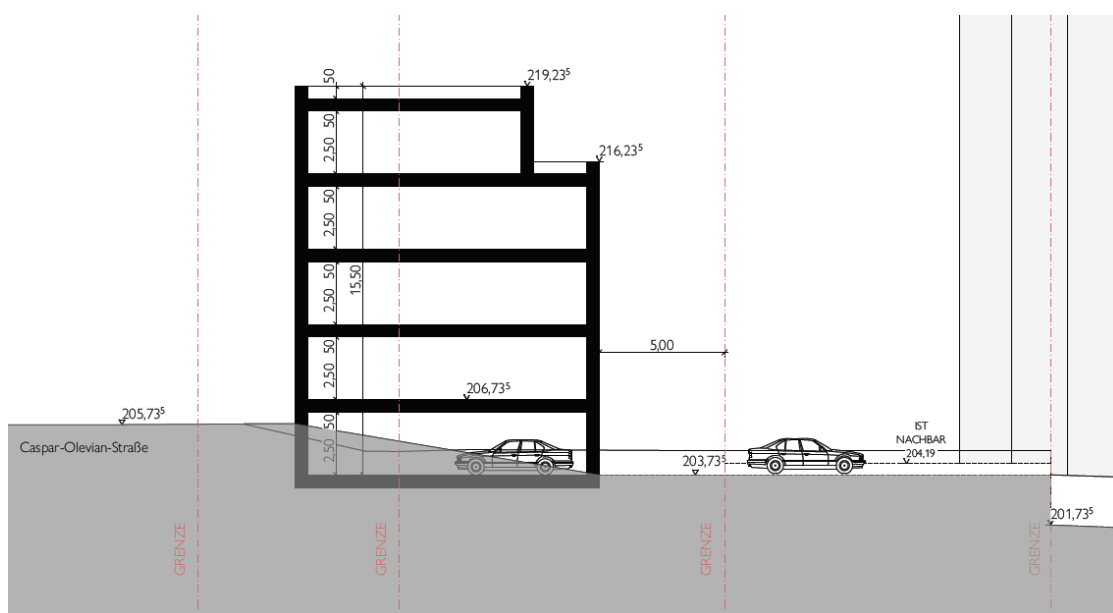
Gebäudeschnitt mit geplanten Oberkanten (Pasucha Klepzig Architekten)
